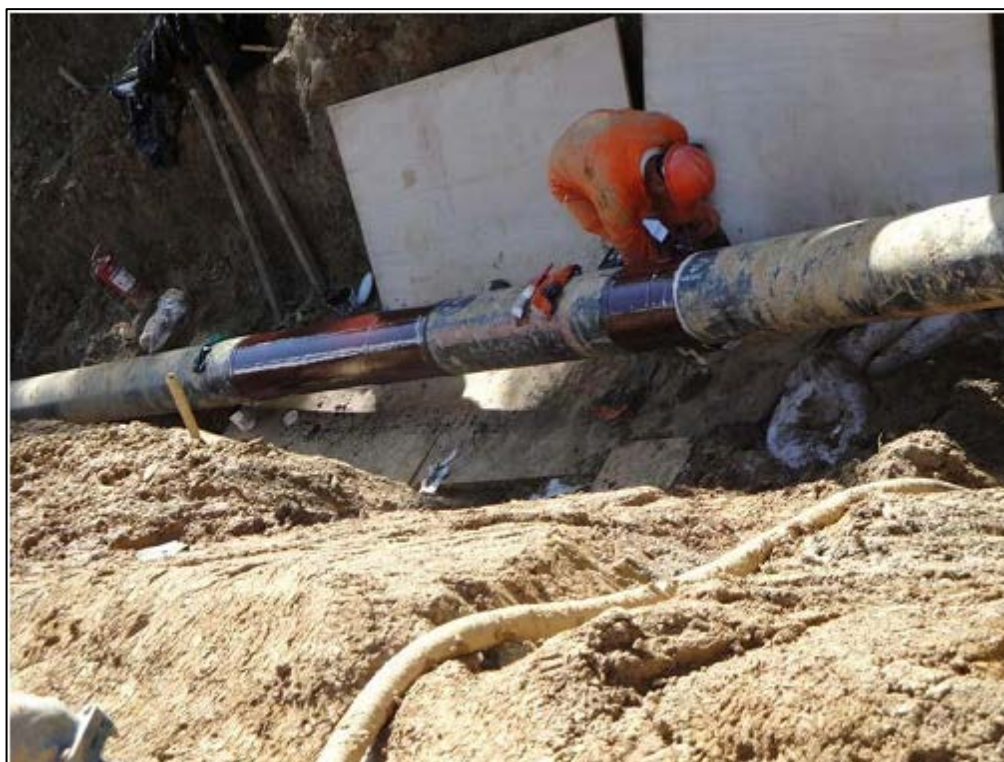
Recubrimiento de soldaduras y tubería tras la reparación.
